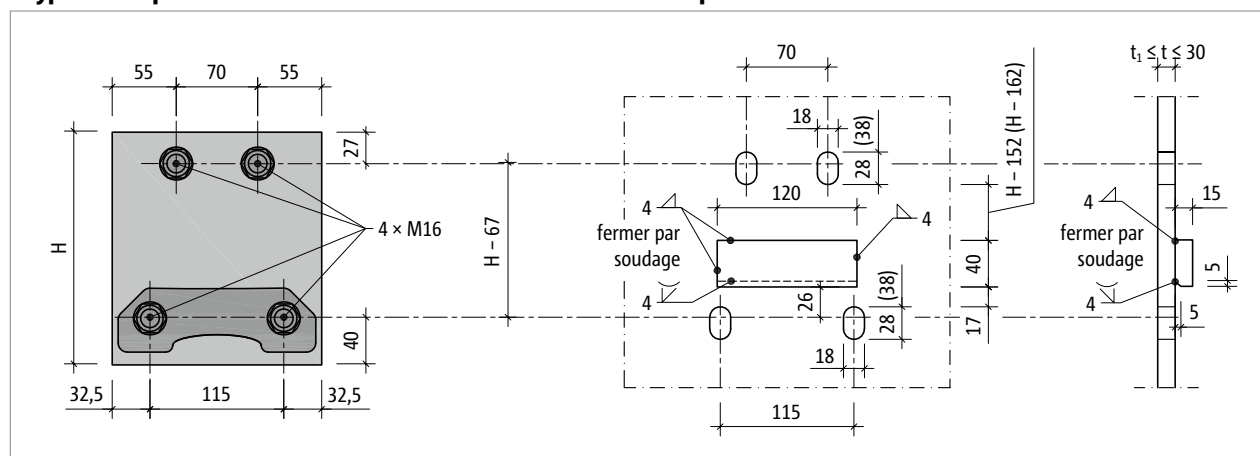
Schöck Isokorb® T type SK-M1 : construction du raccordement de la plaque frontale
